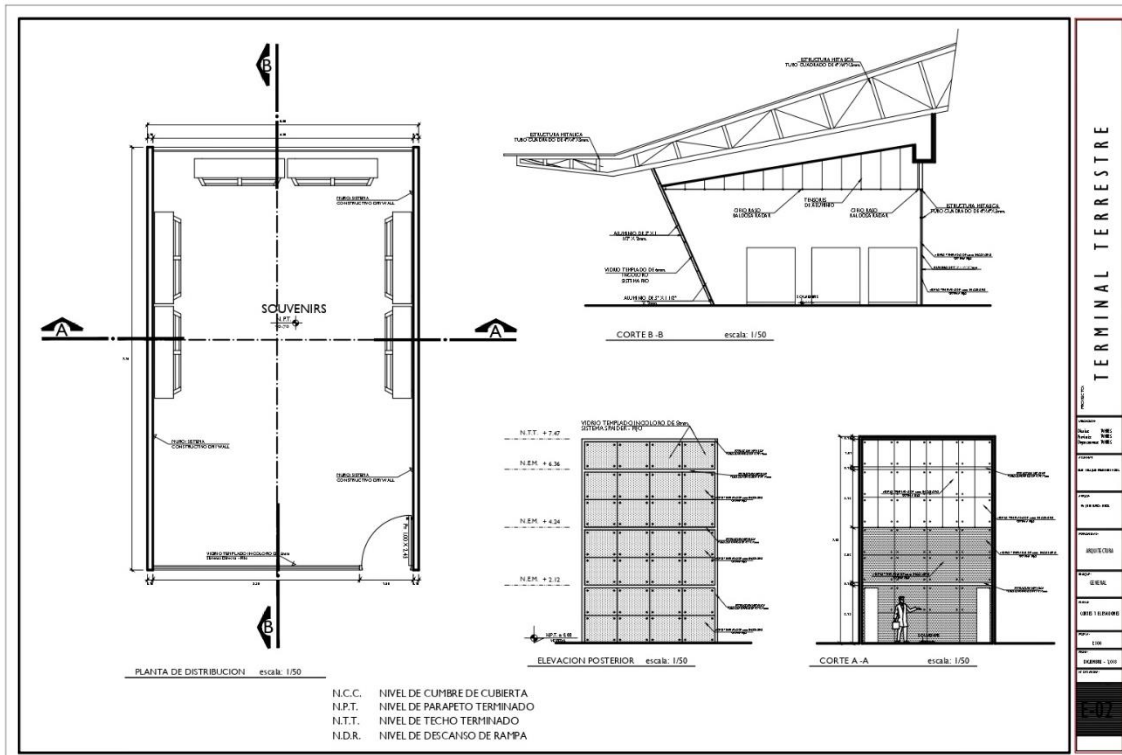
Planta de distribución, elevación y cortes. Elaboración Propia
